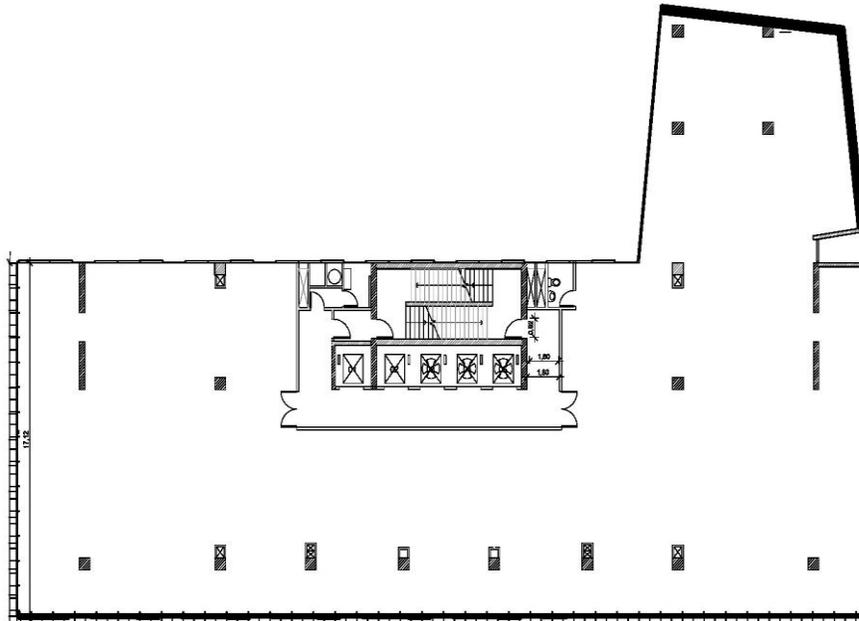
Planta tipo oficinas planta libre Edificio Caja Los Andes Santiago (Providencia)
